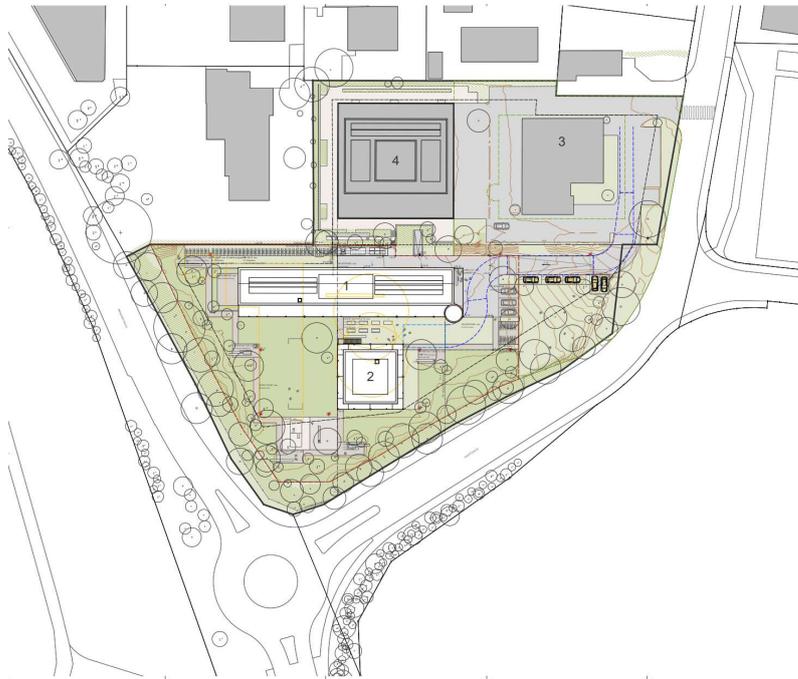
Gesamtareal Zugerstrasse 50, 50a und 52, Steinhausen; mit Ersatzneubau DSS und bestehender Zufahrt (ohne Massstab); 1) Wohnhaus Durchgangsstation; 2) Pavillon Durchgangsstation; 3) altes Laborgebäude; 4) Neubau Amt für Verbraucherschutz
